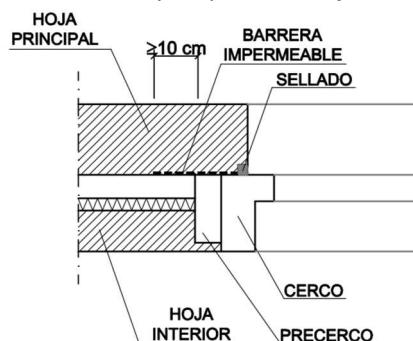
Ejemplo de encuentro de la fachada con la carpintería
